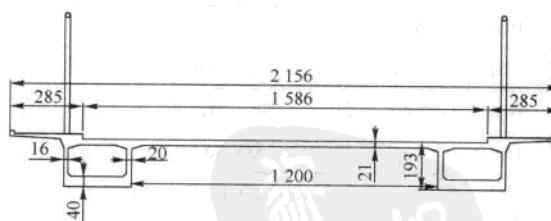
比利时安特卫普莫伯克(Merelbeke)桥混凝土加劲梁横断面图(尺寸单位:cm)
